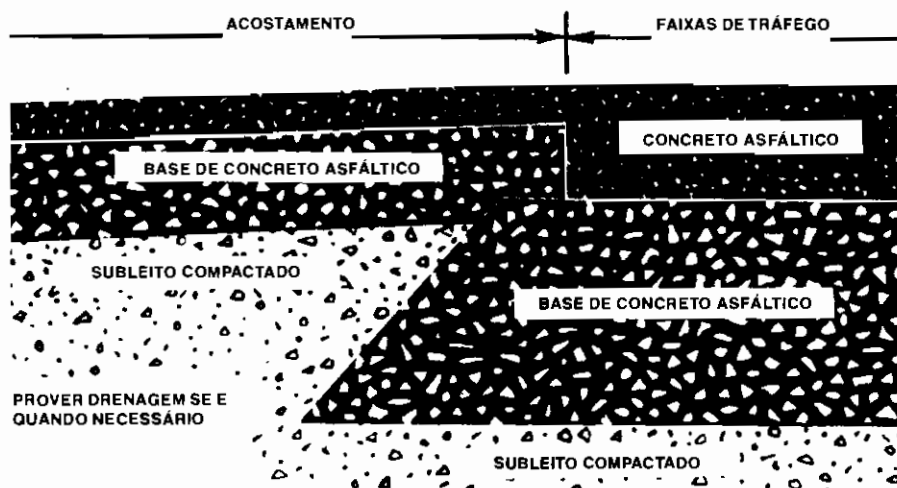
Seção Transversal de Acostamento Sugerido; Pavimento Asfáltico de Espessura Plena.
